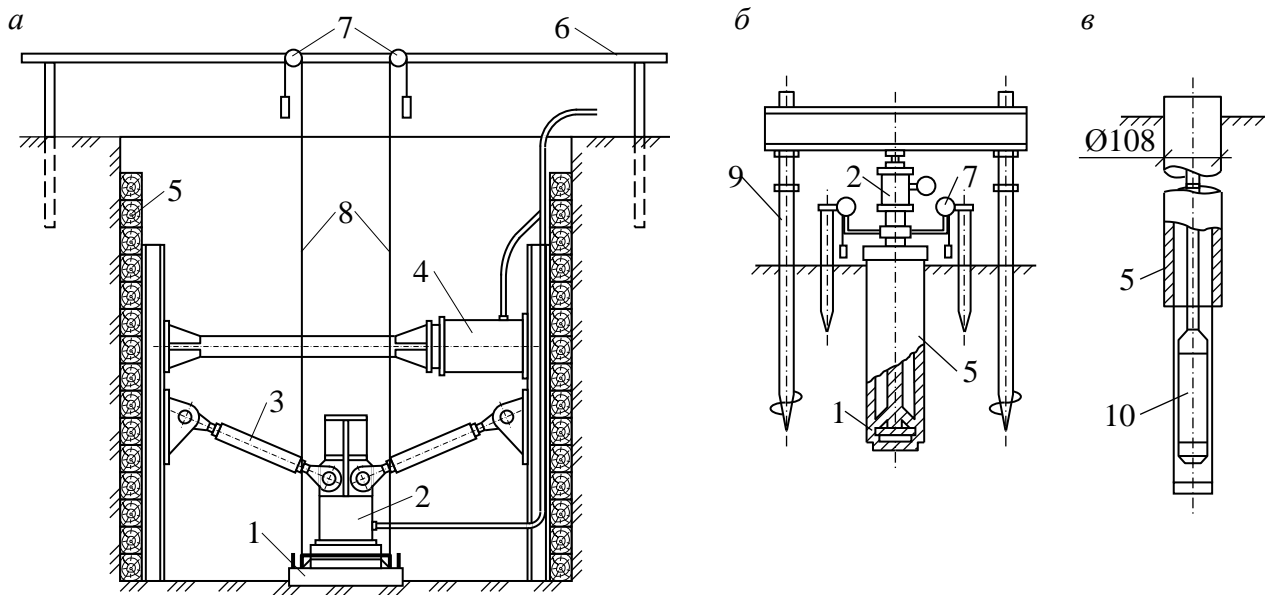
Конструкції установок для випробування ґрунтів на стиснення штампами та пресіометрами: *a* – в шурфах; *б* – у свердловинах; *в* – у свердловинах (пресіометром); 1 – штамп; 2 – домкрат для навантаження штампа; 3 – гвинтові упори; 4 – домкрат для горизонтального розпору; 5 – кріплення стінок шурфу та свердловин; 6 – реперна система; 7 – прогиномір; 8 – дріт; 9 – гвинтовий анкер; 10 – камера пресіометра
